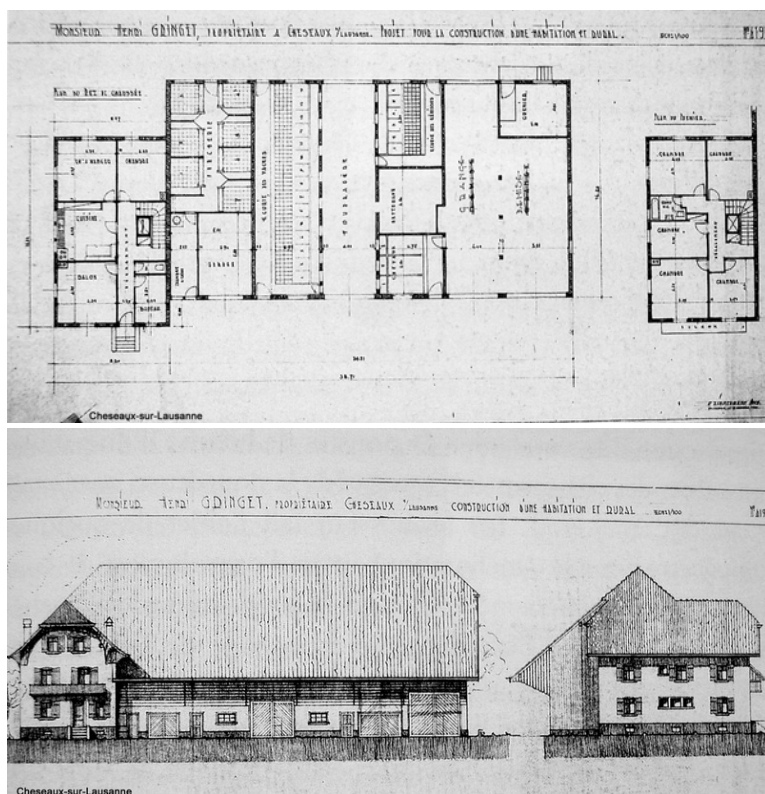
et 97 Élévation de la façade principale et plan d'une ferme reconstruite après l'incendie de 1951 à Cheseaux-sur-Lausanne.
